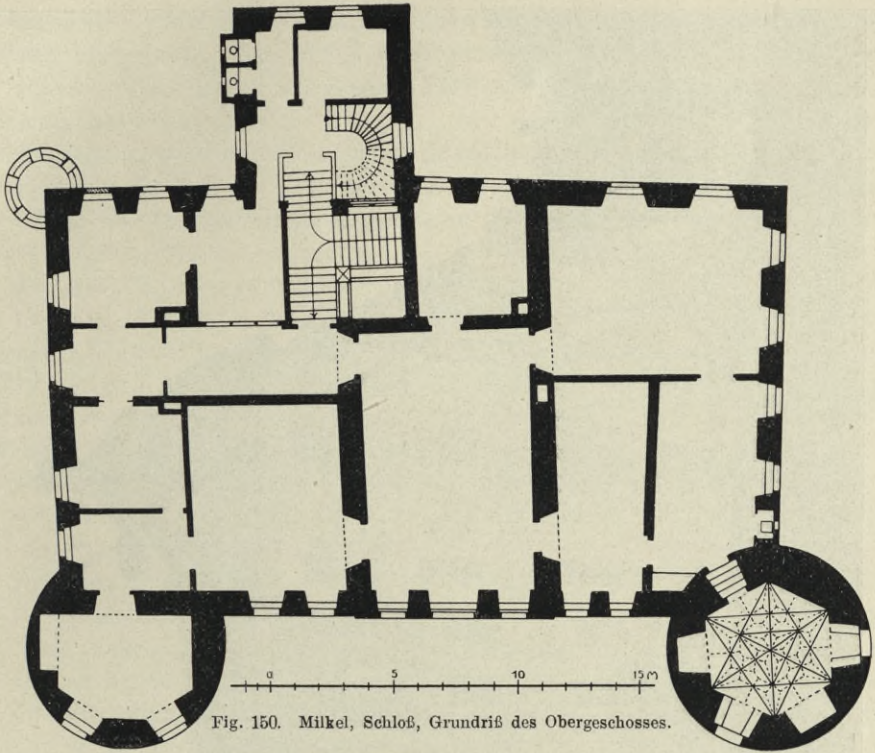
Milkel, Schloß, Grundriß des Obergeschosses.
